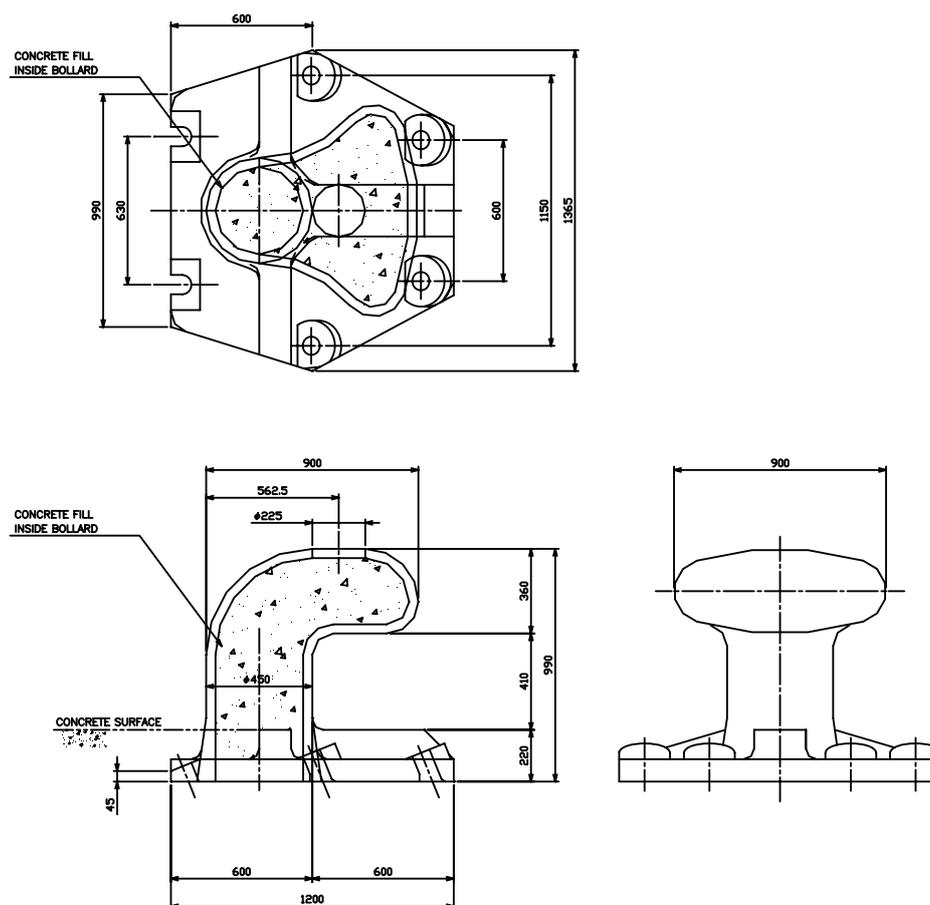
Cabeço de Amarração Proposto do Tipo 1000 kN
